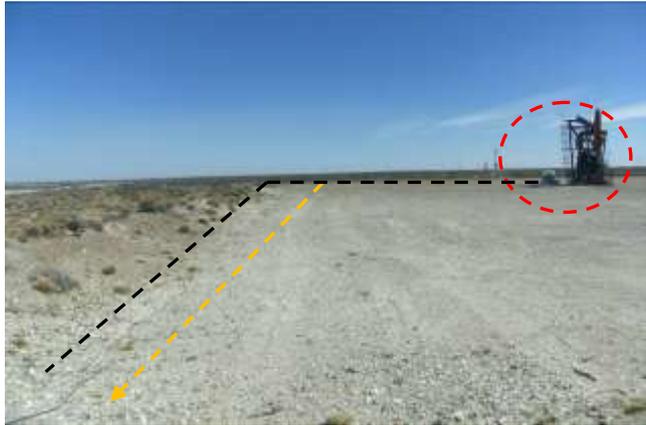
Emplazamiento de oleoducto por locación del Pozo LC.a-728. Se observa AIB (rojo). Foto en dirección O.
